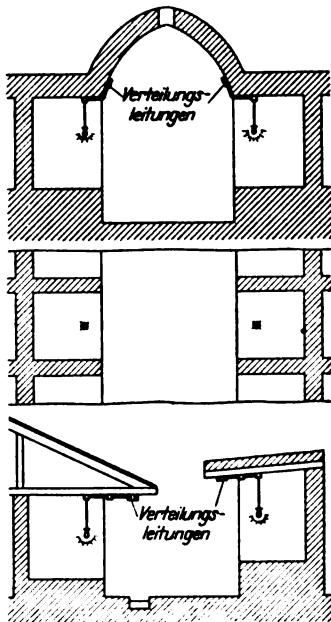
Bauweise und Lichtinstallation in einer gedeckten (oben) und offenen (unten) Bazarstraße.
